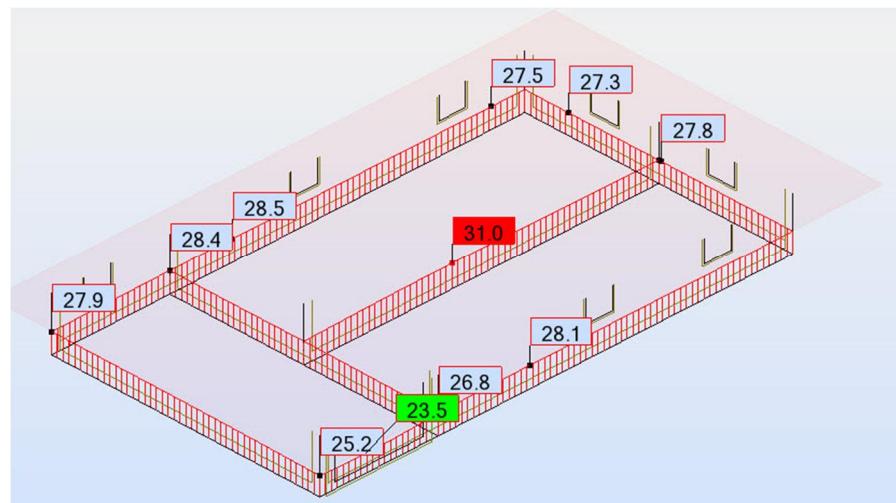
Линейные нагрузки на фундамент (по ПС1), в кН/м.
